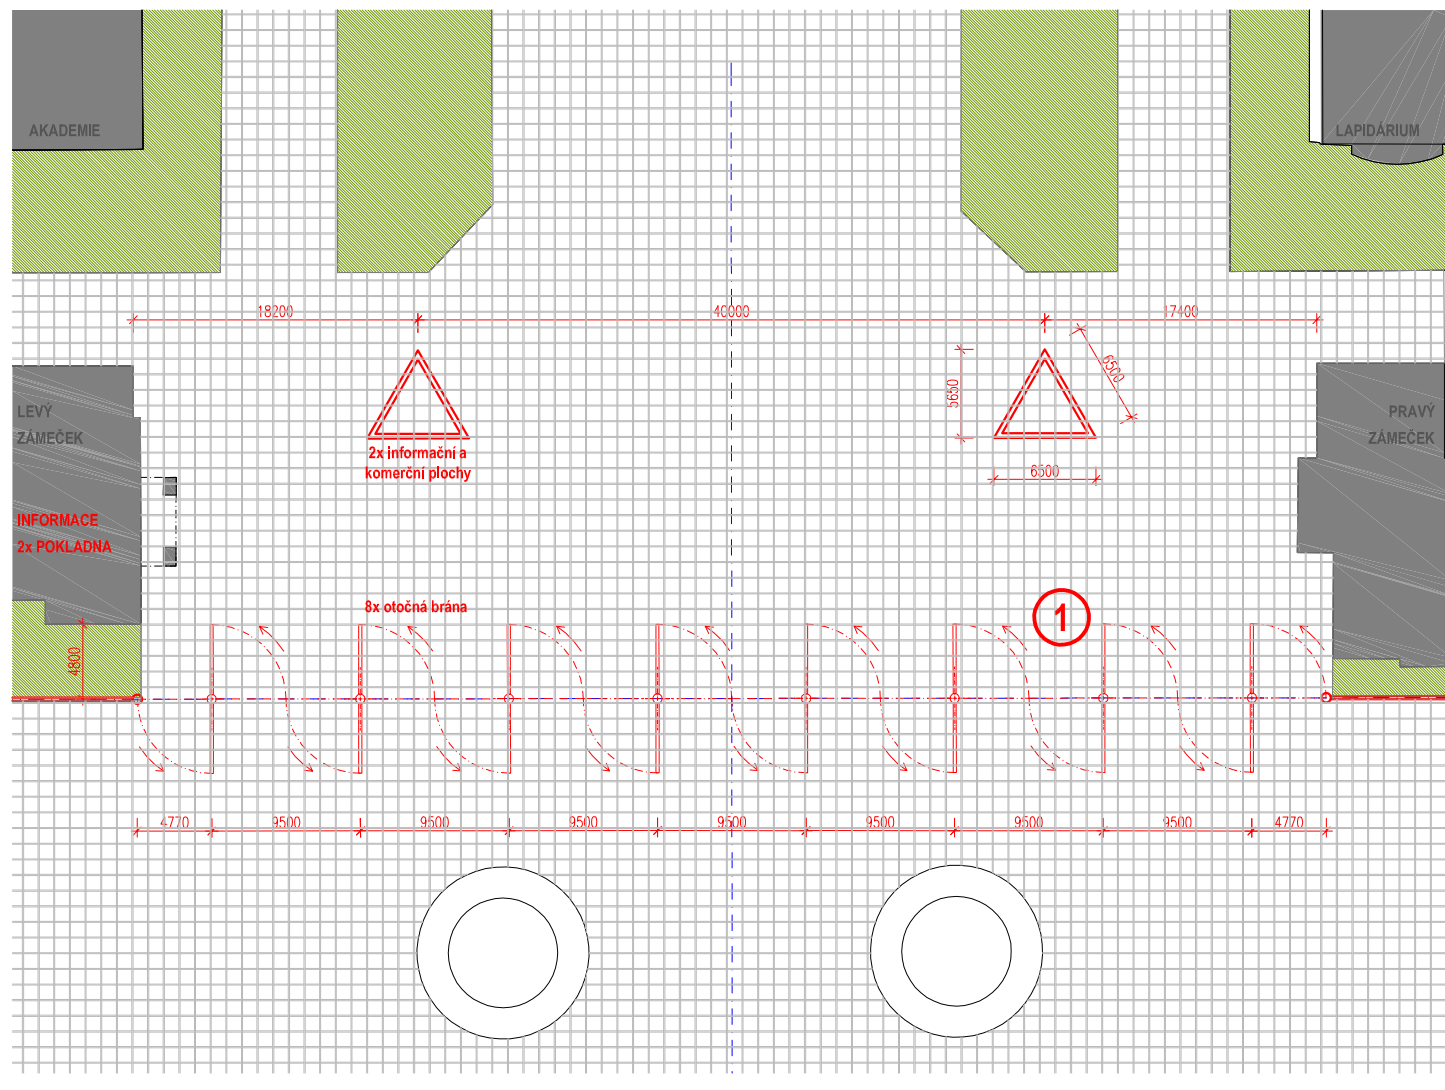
DETAIL BRÁNY - PŮDORYS V REŽIMU "OTEVŘENO"
